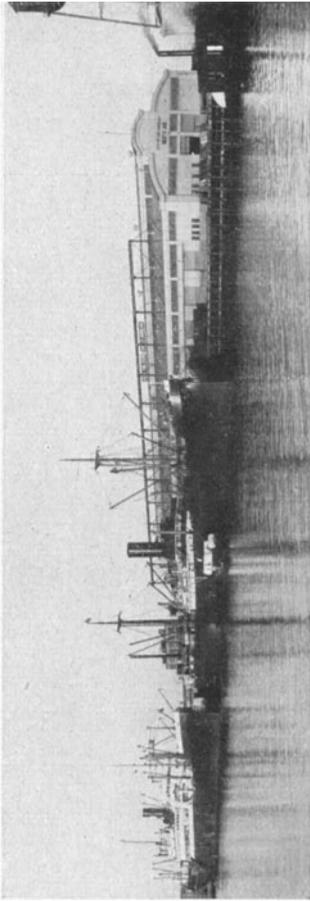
Eingeschossiger Beton-Pierschuppen.
